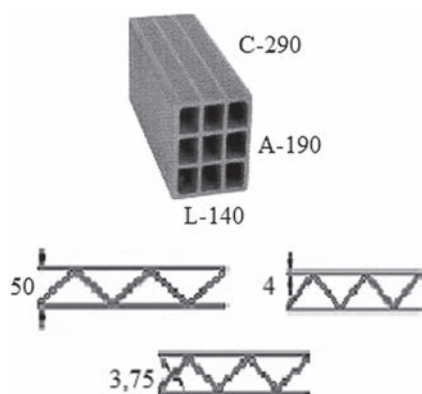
Detalhes do bloco e da armadura de junta (dimensões em mm): (a) bloco cerâmico furado de vedação; (b) armadura em treliça de aço galvanizado (armadura Murfor / RND-Z. 4/50).
